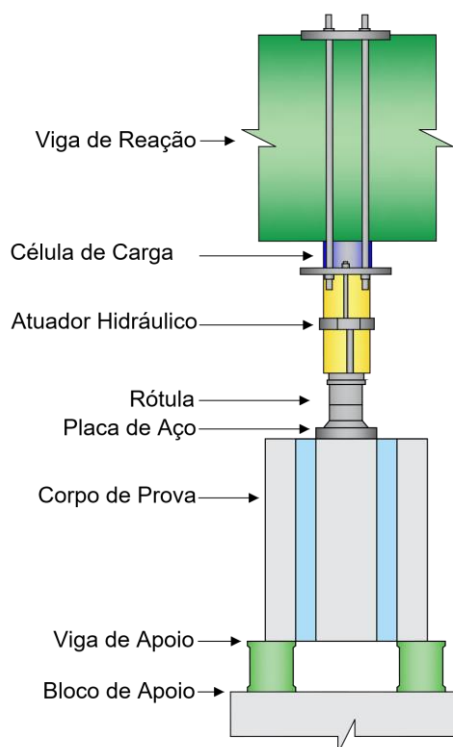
Ensaio *push-out* executado para determinação do carregamento último de conectores de cisalhamento para paredes pré-moldadas de concreto com isolamento incorporado.
